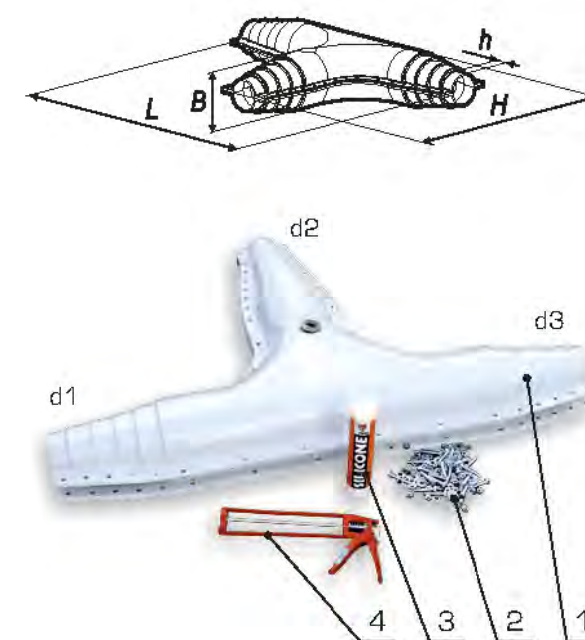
Общий вид комплекта для изоляции пресс-тройника
